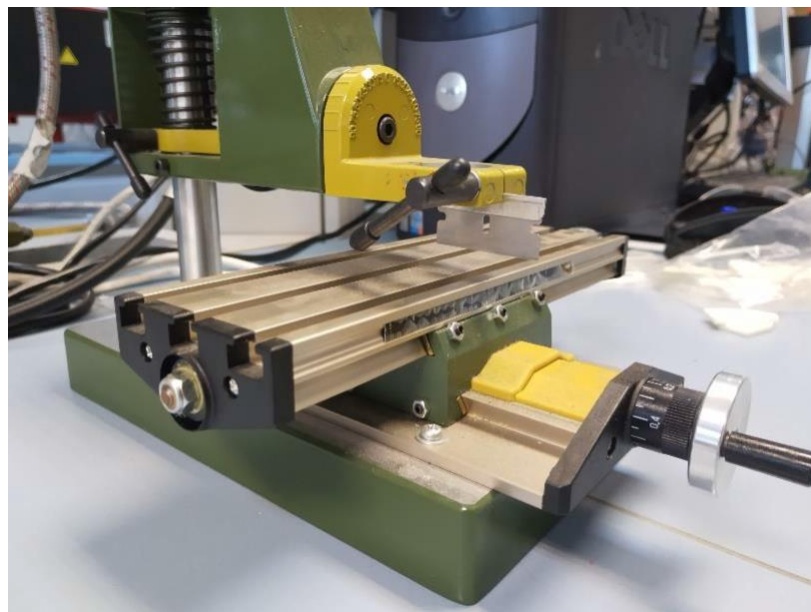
Montaje para introducir grietas entallas mediante la técnica “Sliding”
